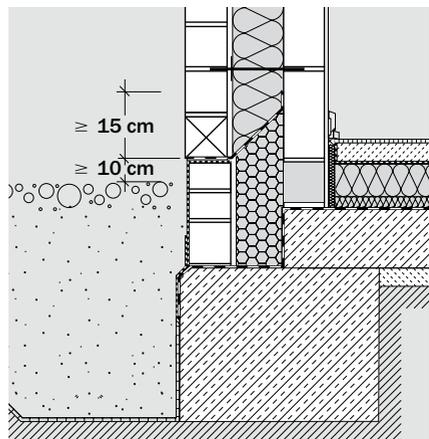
/24: Fußpunktausbildung nicht unterkellerten Gebäude
